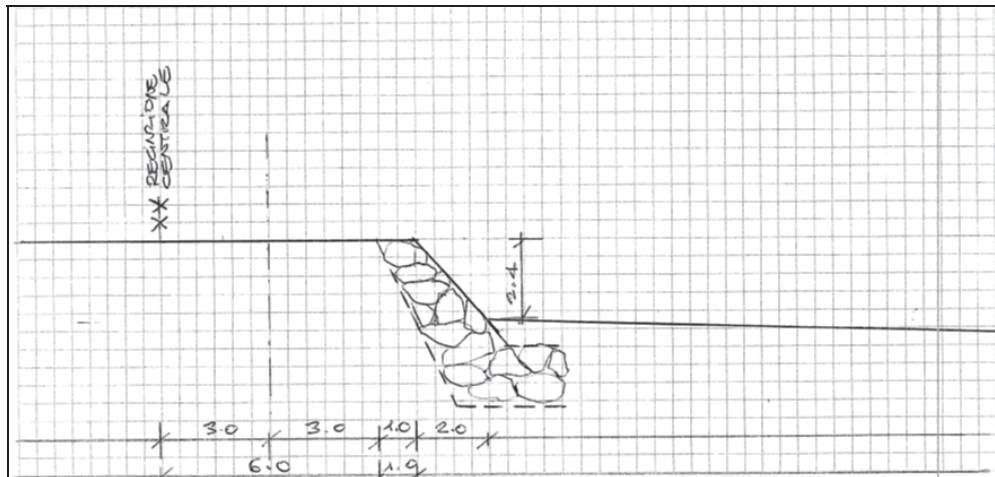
Sezione trasversale tipo rappresentativa del tratto
